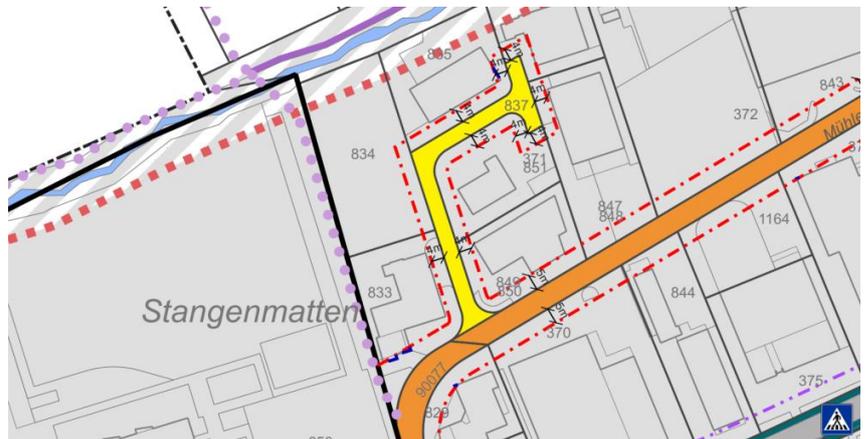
Überführung Abzweiger Mühlemattstrasse in eine Erschliessungsstrasse
